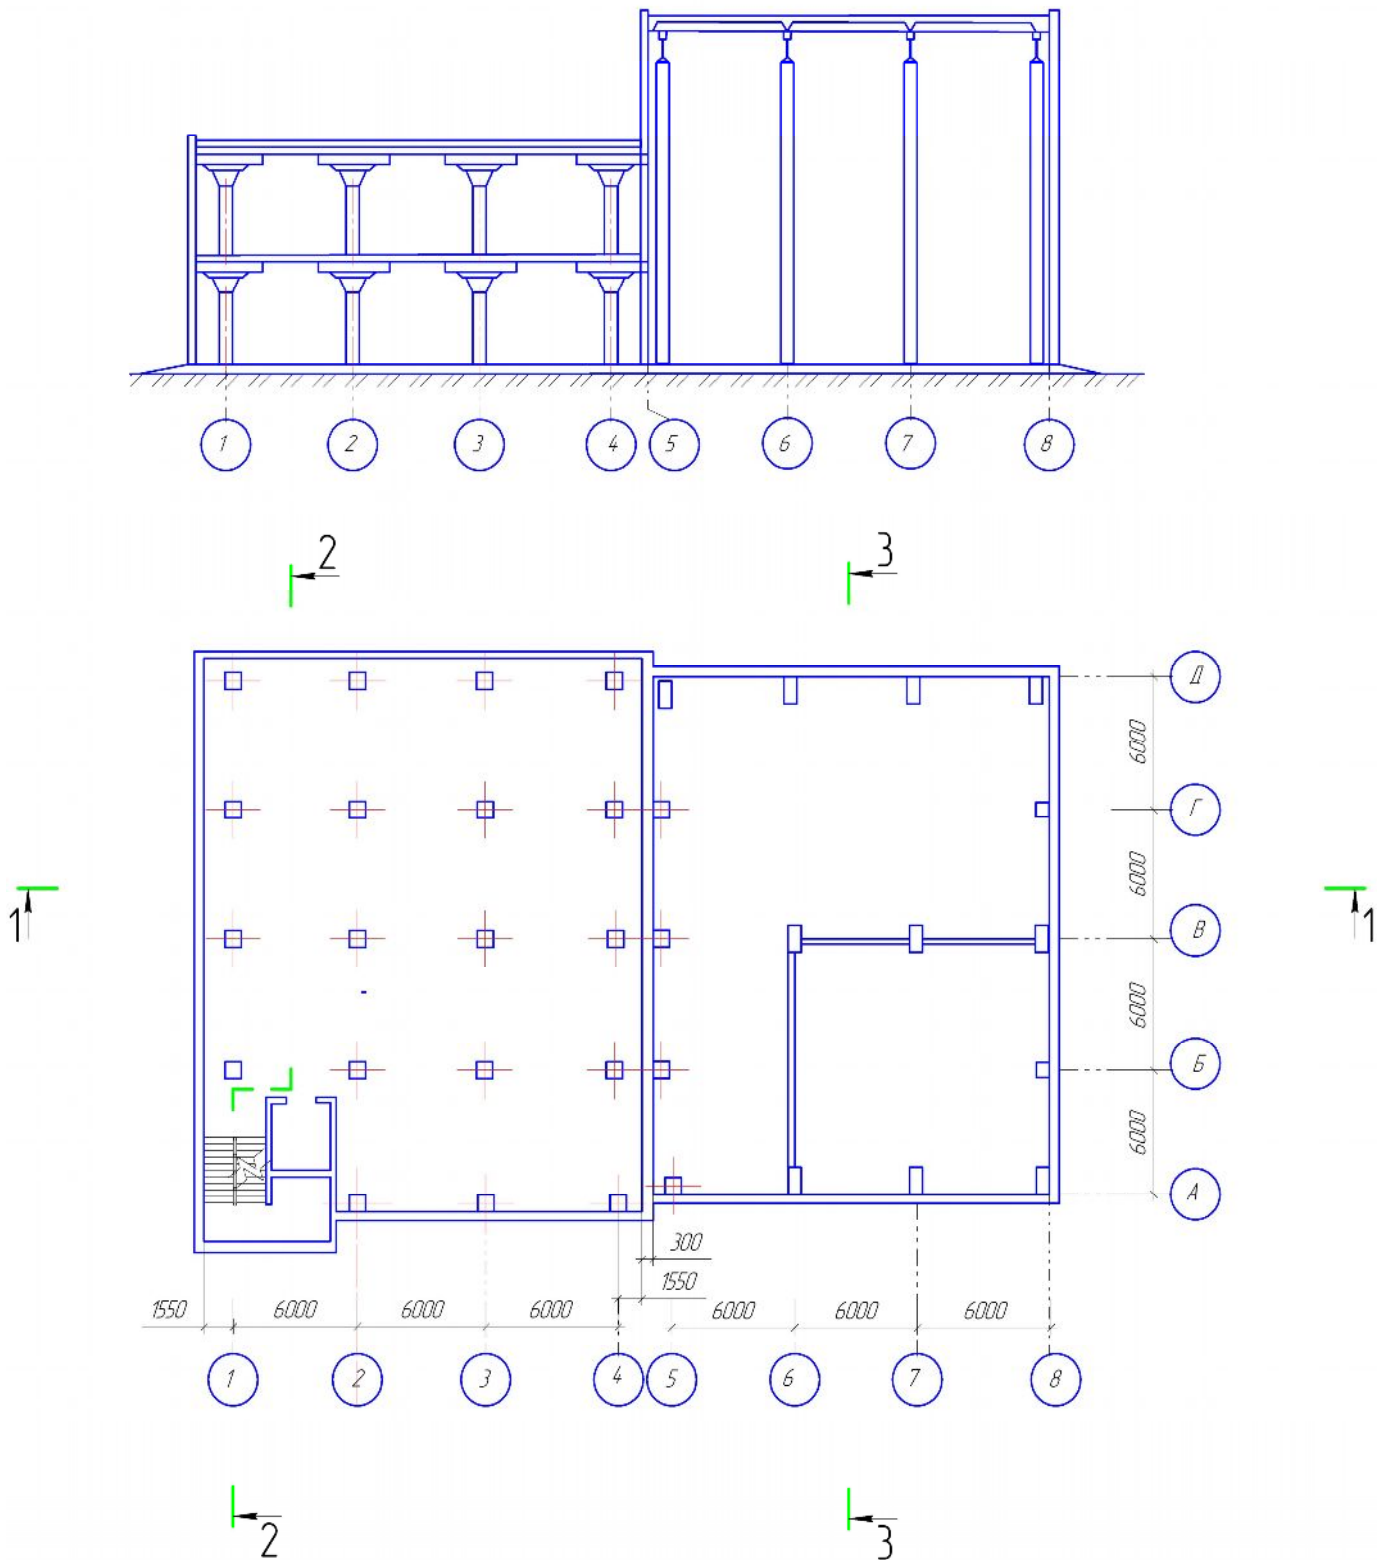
Схема плану та розрізу промислової будівлі до завдання контрольної роботи
